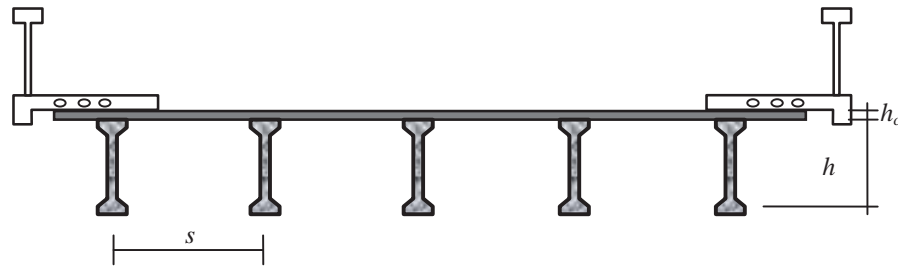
Esquema de la sección transversal tipo en losas sobre vigas con sección I
